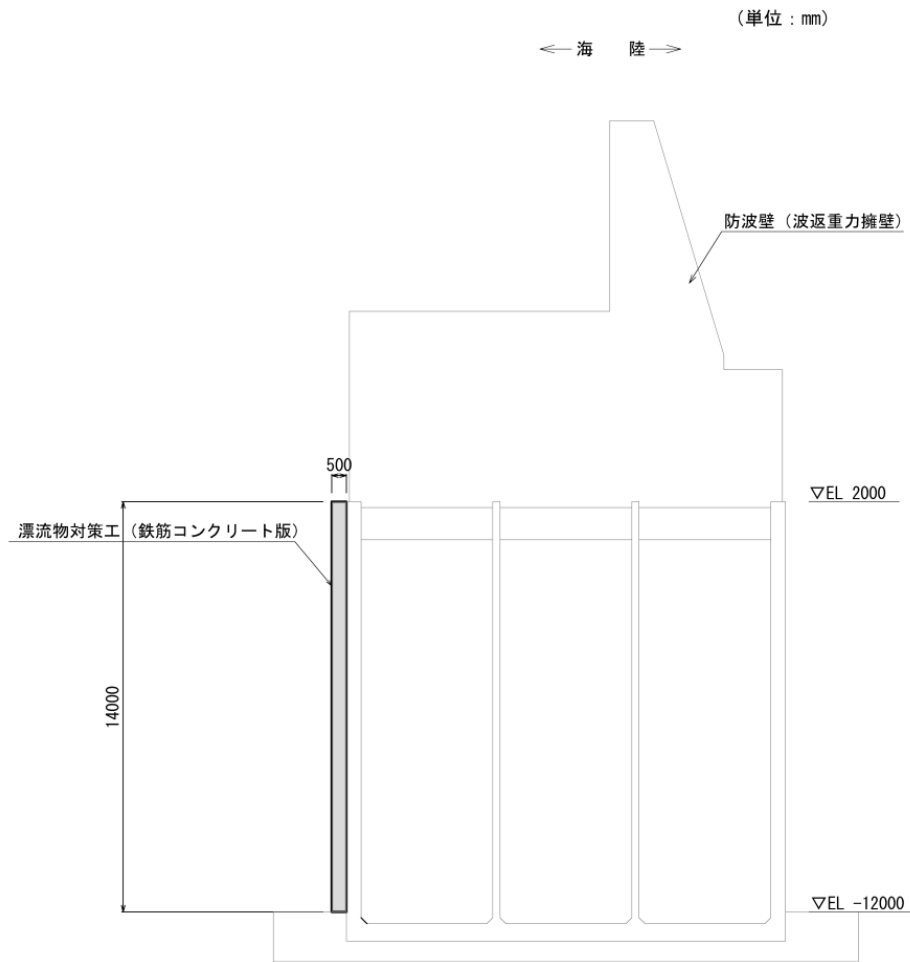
漂流物対策工⑧の構造概要図 (断面図)
